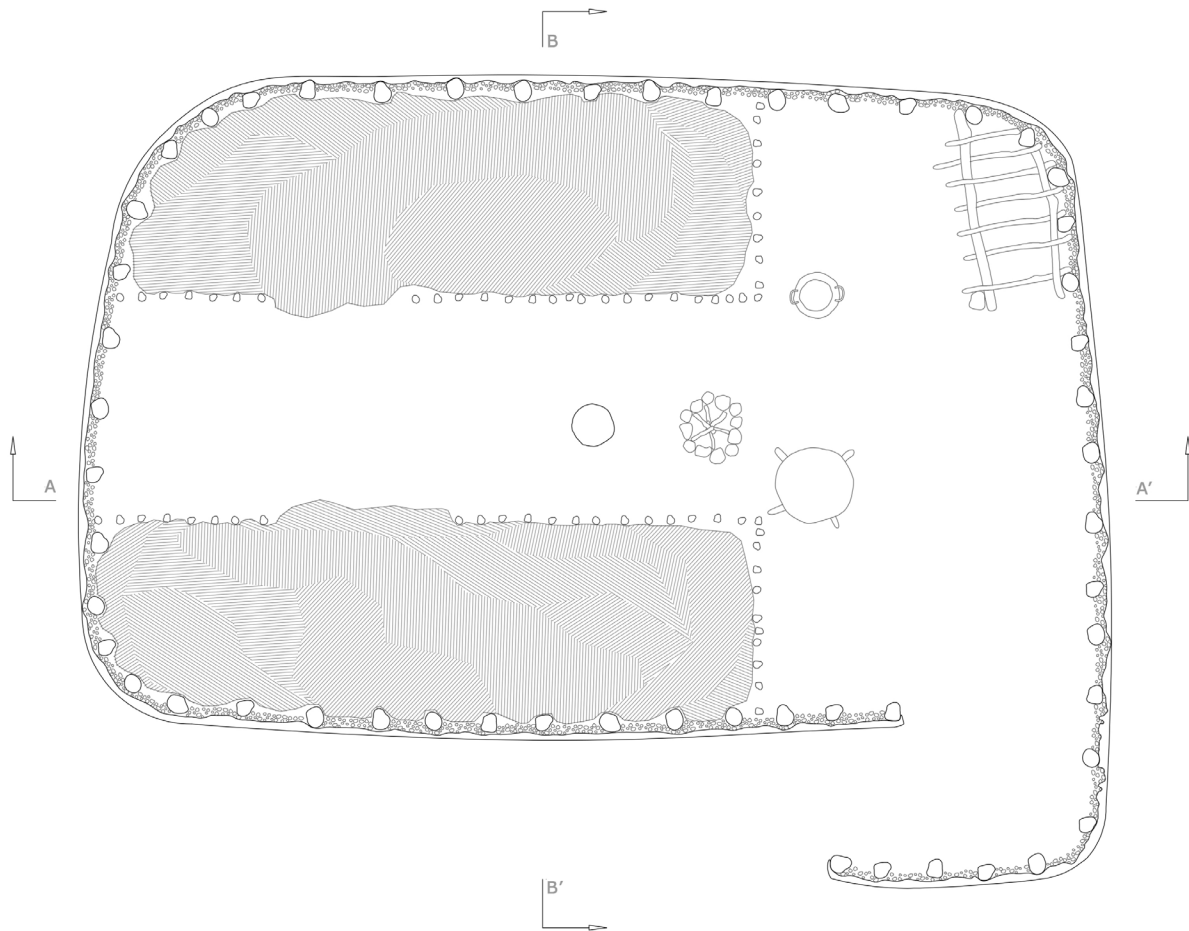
(Plano de elaboración propia). Dibujo en planta de la manyatta.
